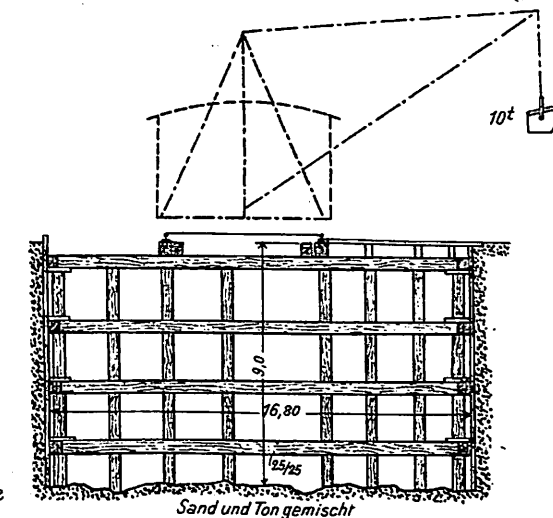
Aussteifung am Einsturze des Tunnels unter der Lexington-Avenue der Untergrundbahnen in Neuyork. Maßstab 1:200.
